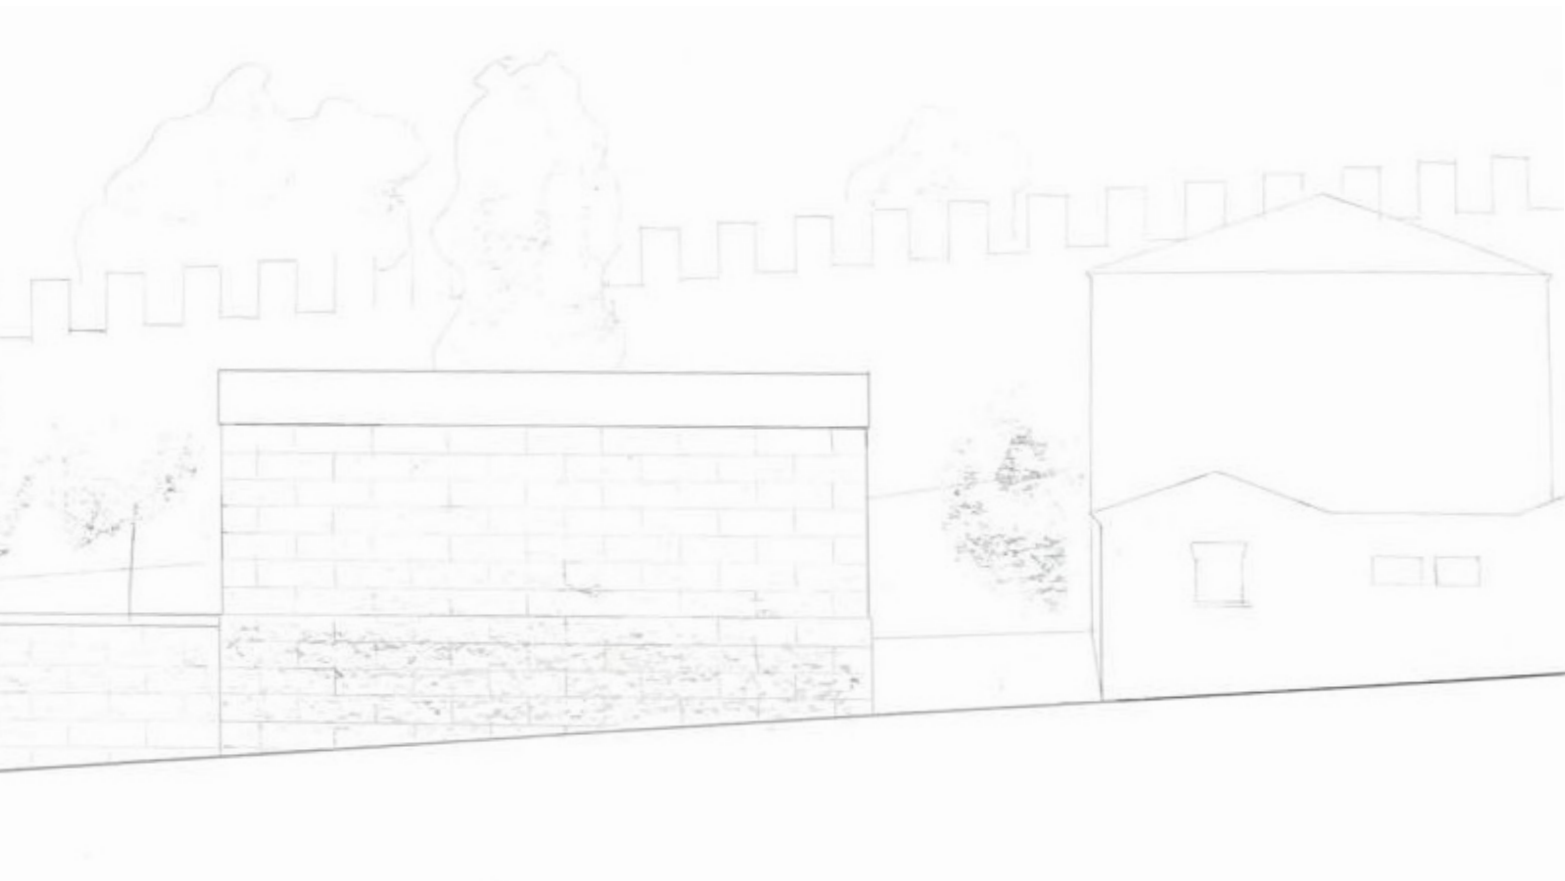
Realizado posteriormente aos painéis – Alçado norte, escala 1:100.
